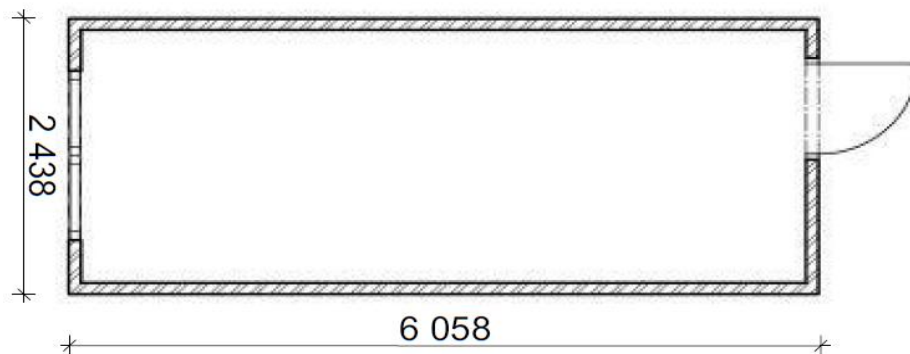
3 Půdorys fekálního tanku TOI TOI
